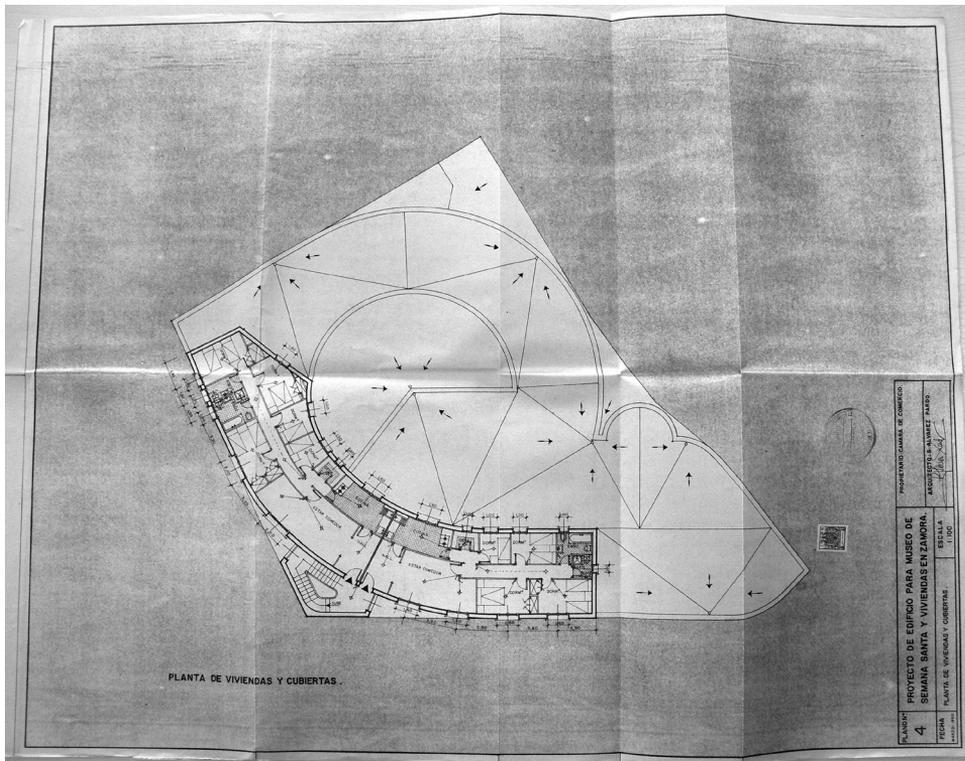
Plano 4, planta de viviendas y cubiertas del museo de Semana Santa. Salvador Álvarez Pardo, 1960.
